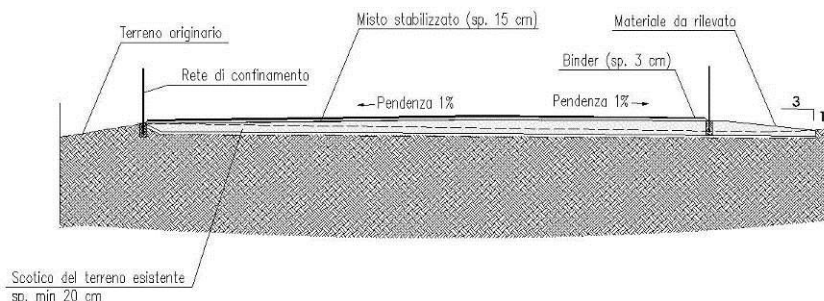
Particolare delle pavimentazioni delle aree di cantiere
